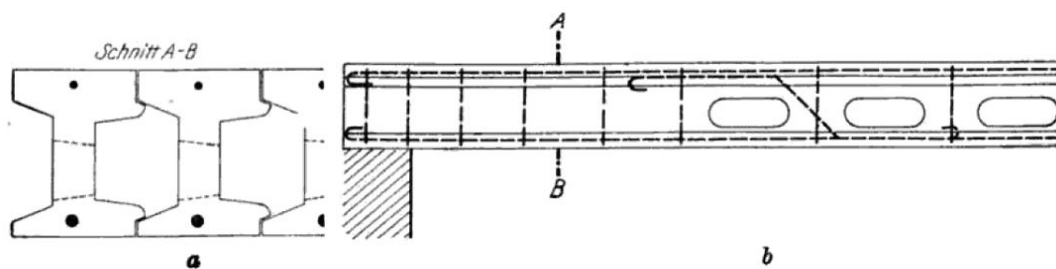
Typische Stahlbetonträgerdecke [14]
